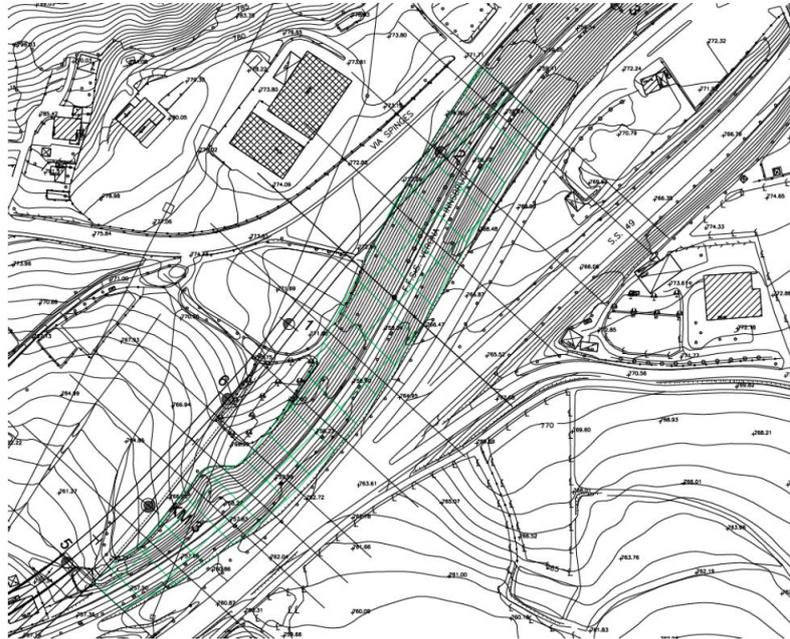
San Candido: Naz Sciaves Planimetria
